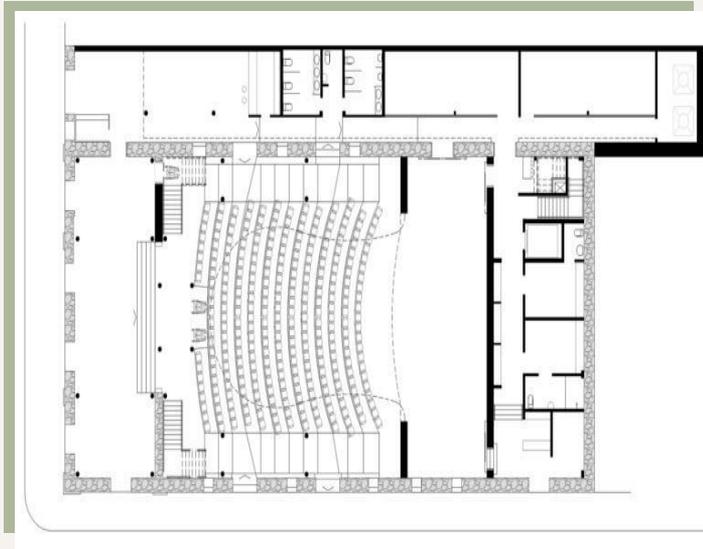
PLANTA TÉRREO DO PROJETO DE RESTAURO DO TEATRO GUARANY.
